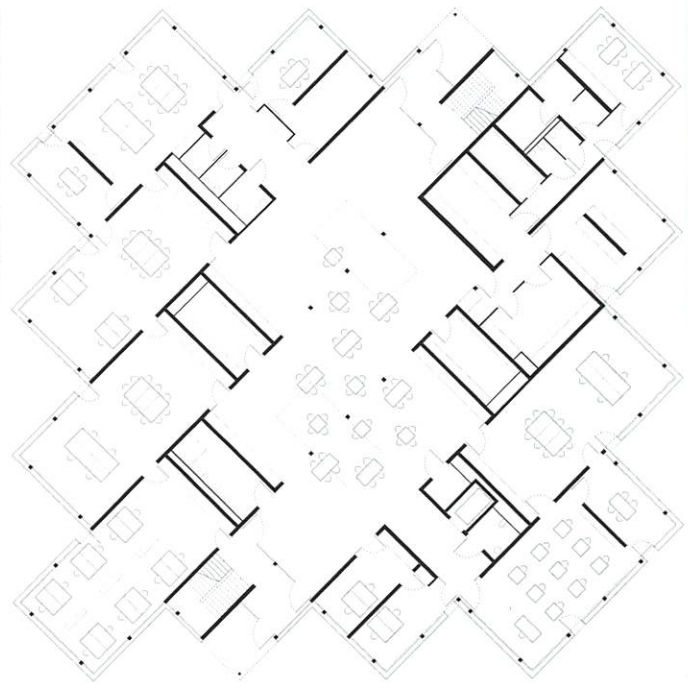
Wabenartiger Grundriss des Erdgeschosses
